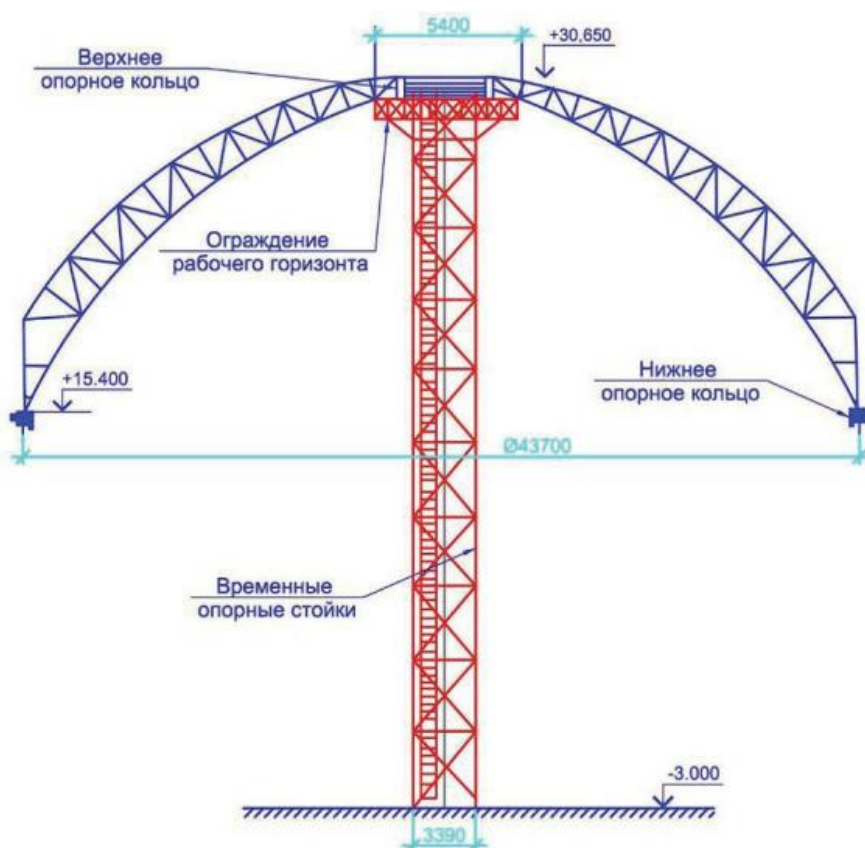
Схема устройства опорной башни и верхнего опорного кольца для главных ферм
